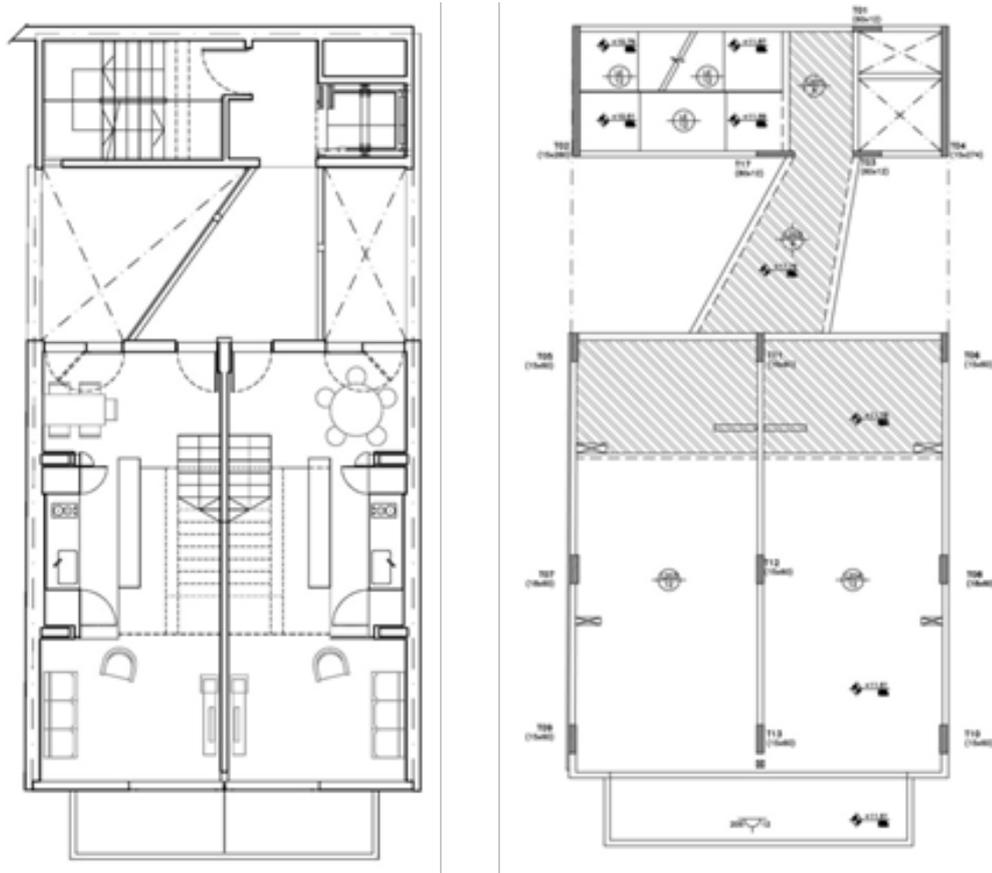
Planta de arquitectura y planta de estructura del nivel inferior de los Dúplex. Fuente: Estudio de arquitectura A3 Digital
